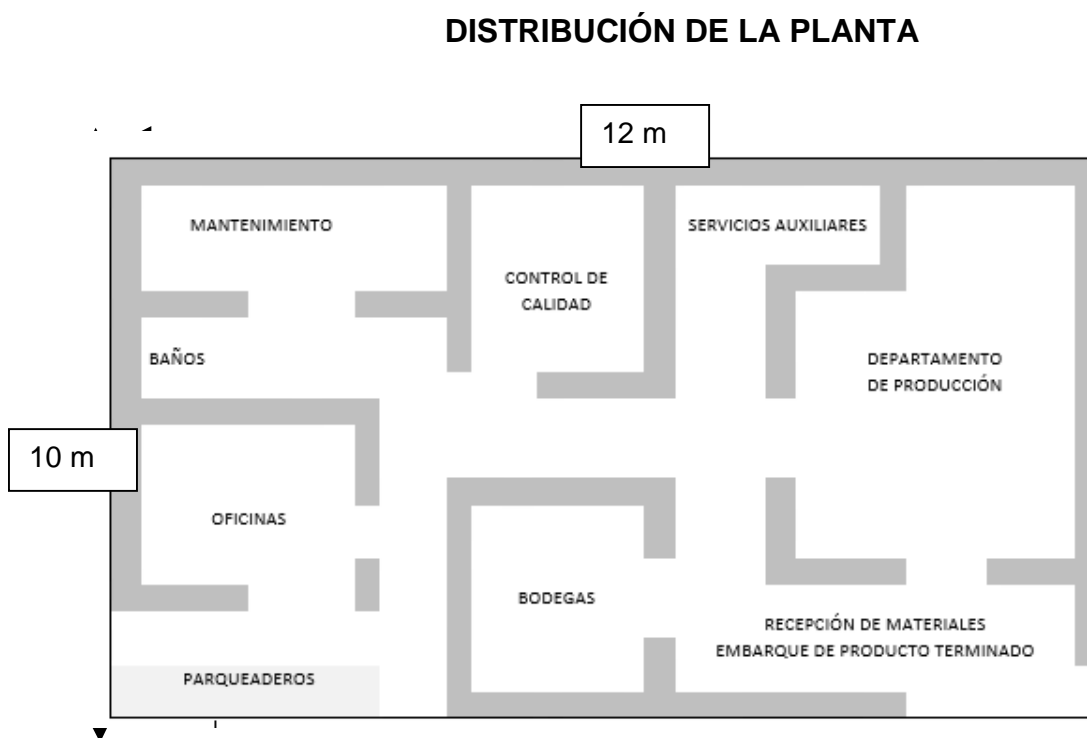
Distribución de la planta en base a las buenas prácticas de manufactura.
